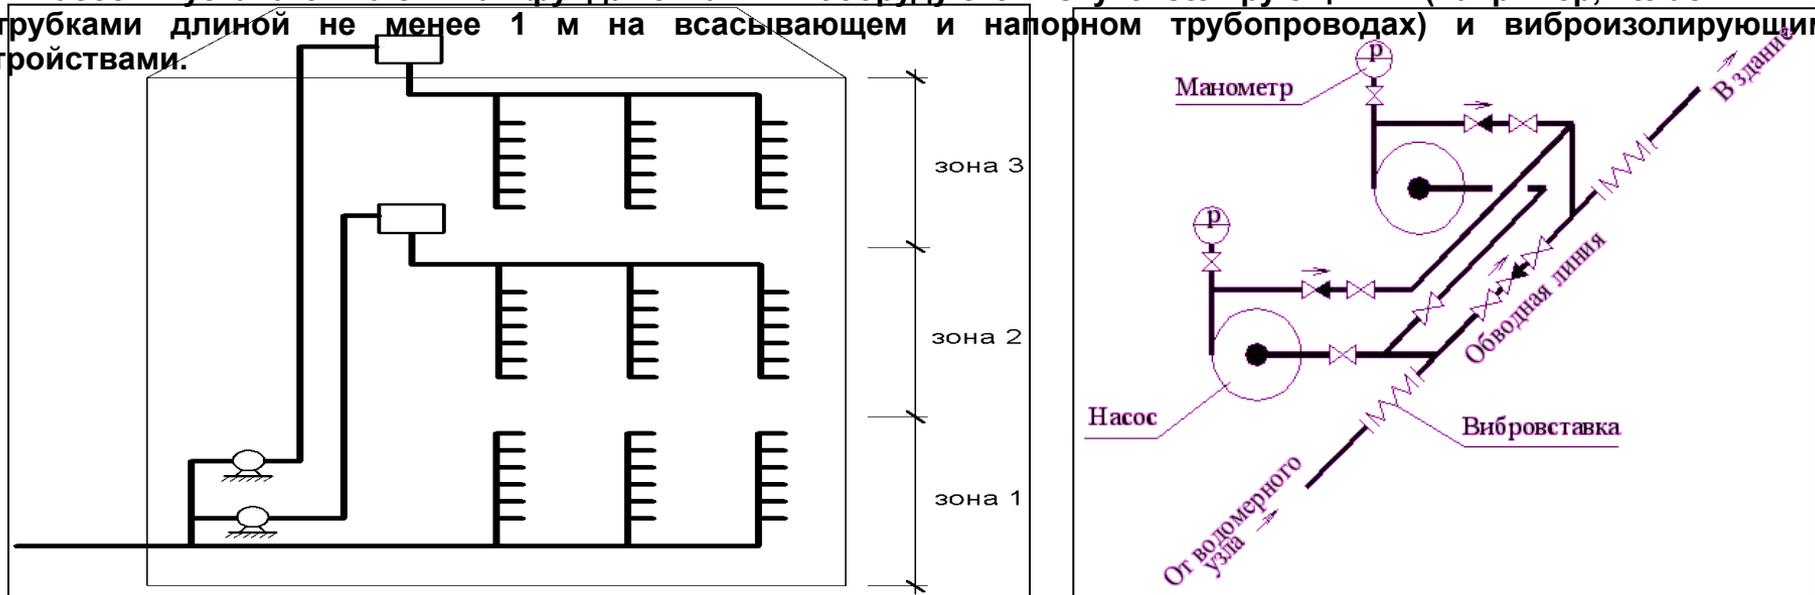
Схема водоснабжения здания с параллельным зонированием
